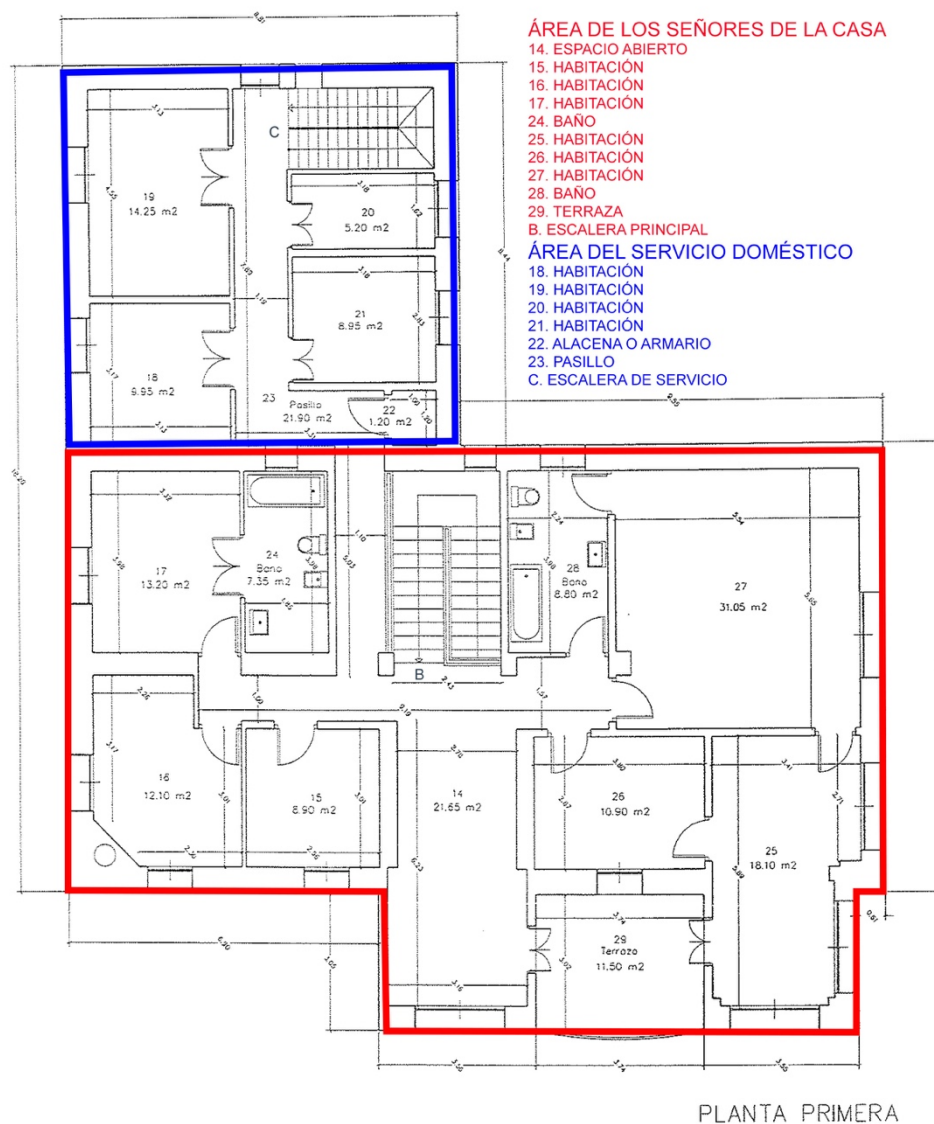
Plano de la planta primera de la casa de la Finca La Parra. Fuente: Elaboración propia en base a plano de AENA.
